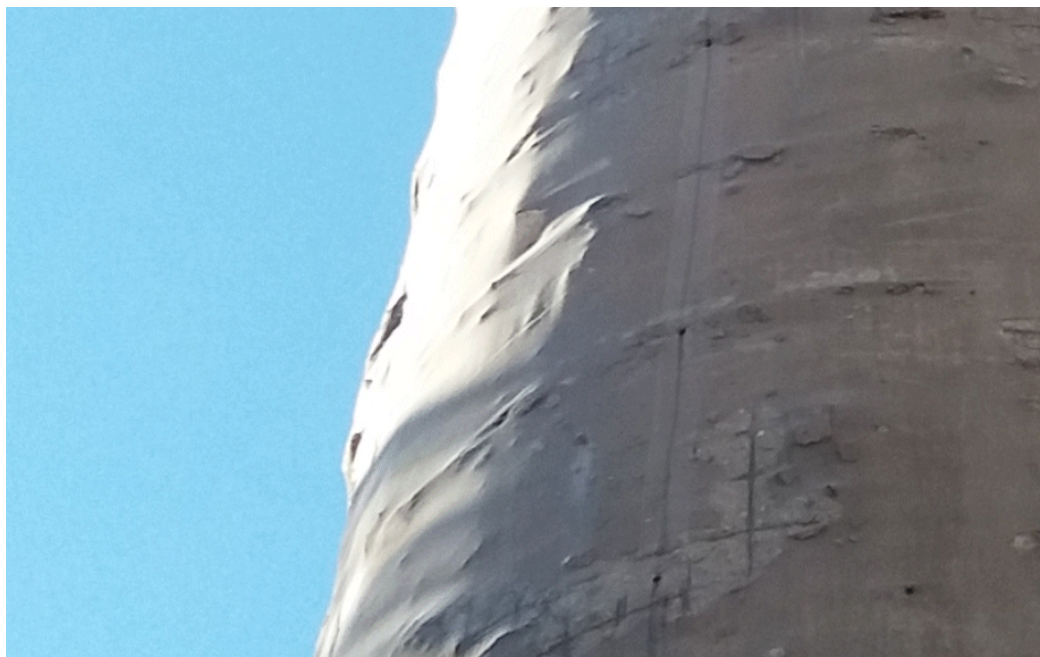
Pilone 1 – Lato Sud-Est – Particolare foto 6
